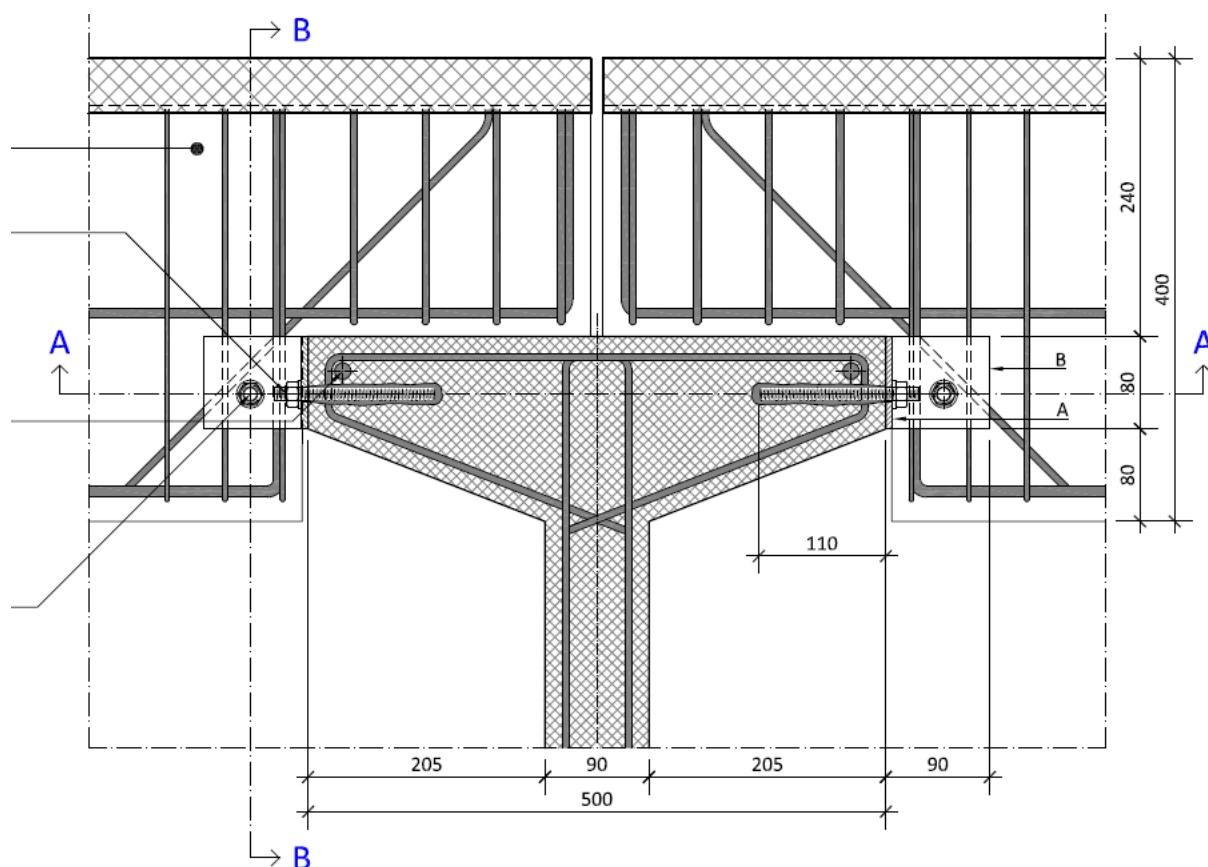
Intervento 01a – Sezione parallela ai tegoli
